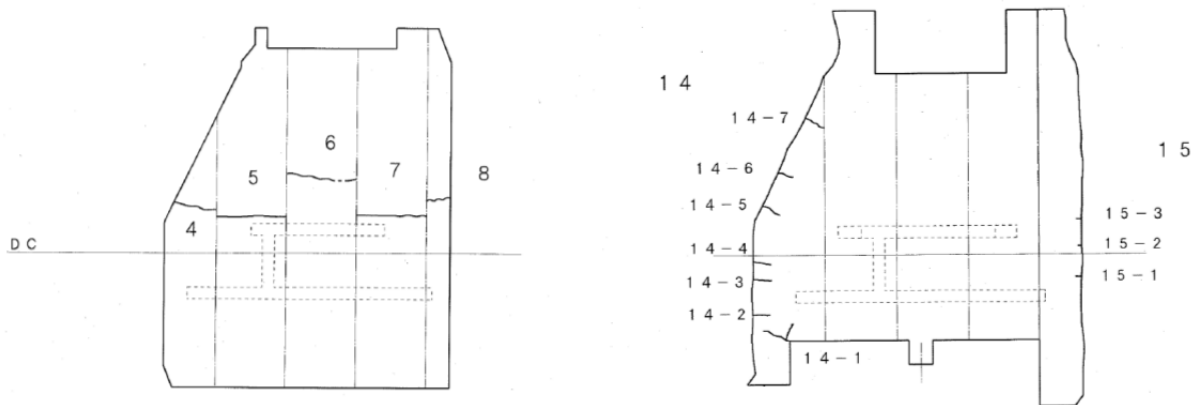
着岩コンクリートに発生したひび割れ
